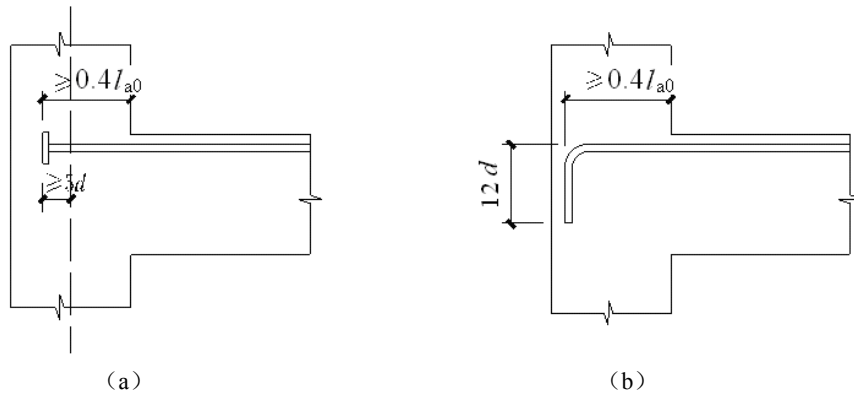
梁上部纵向钢筋在中层端节点内的锚固
